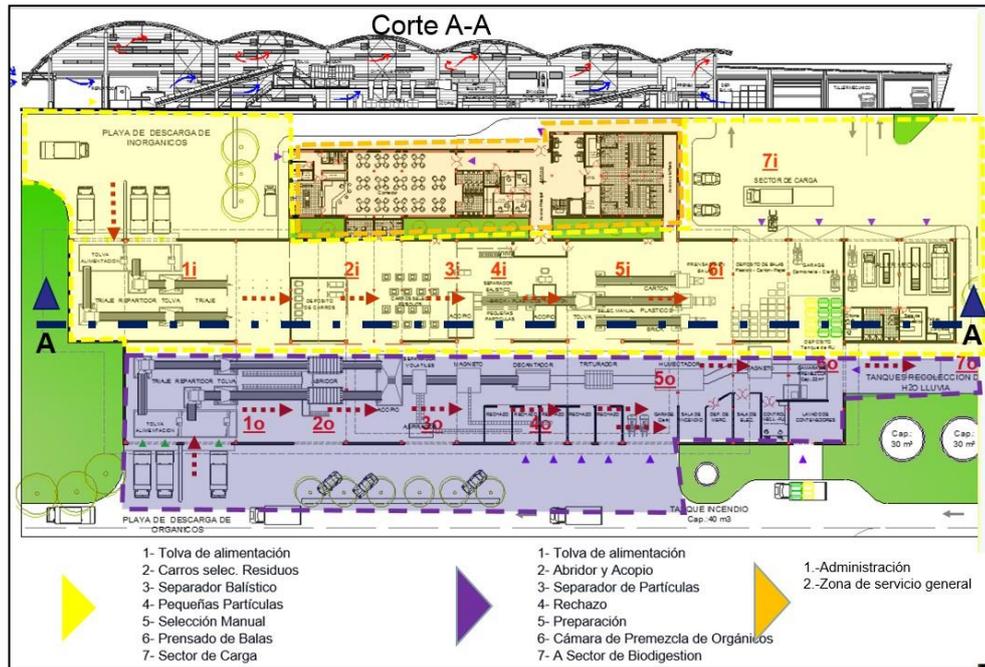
Distribución de 1 piso, Planta de tratamiento de “RSU” con producción de energías renovables- empresa COGERSA
